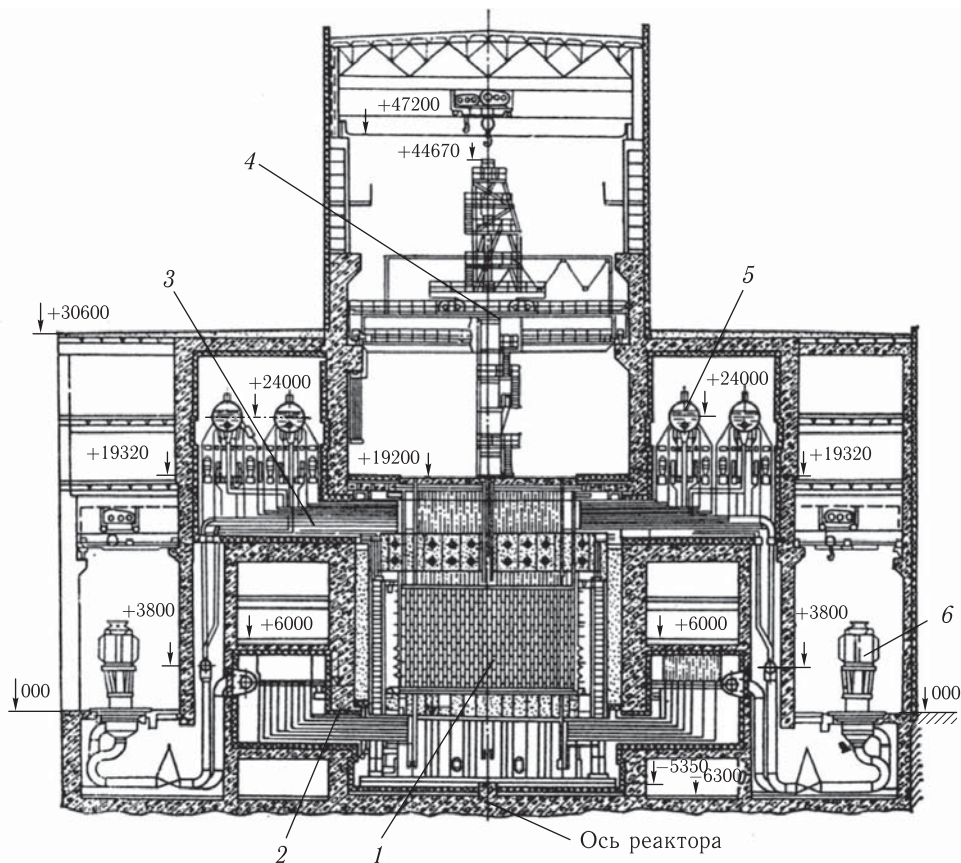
, а. Схема реактора РБМК-1000: 1 — активная зона; 2 — трубы входной воды; 3 — отвод пароводяной смеси; 4 — перегрузочная машина; 5 — сепаратор; 6 — питательный насос
